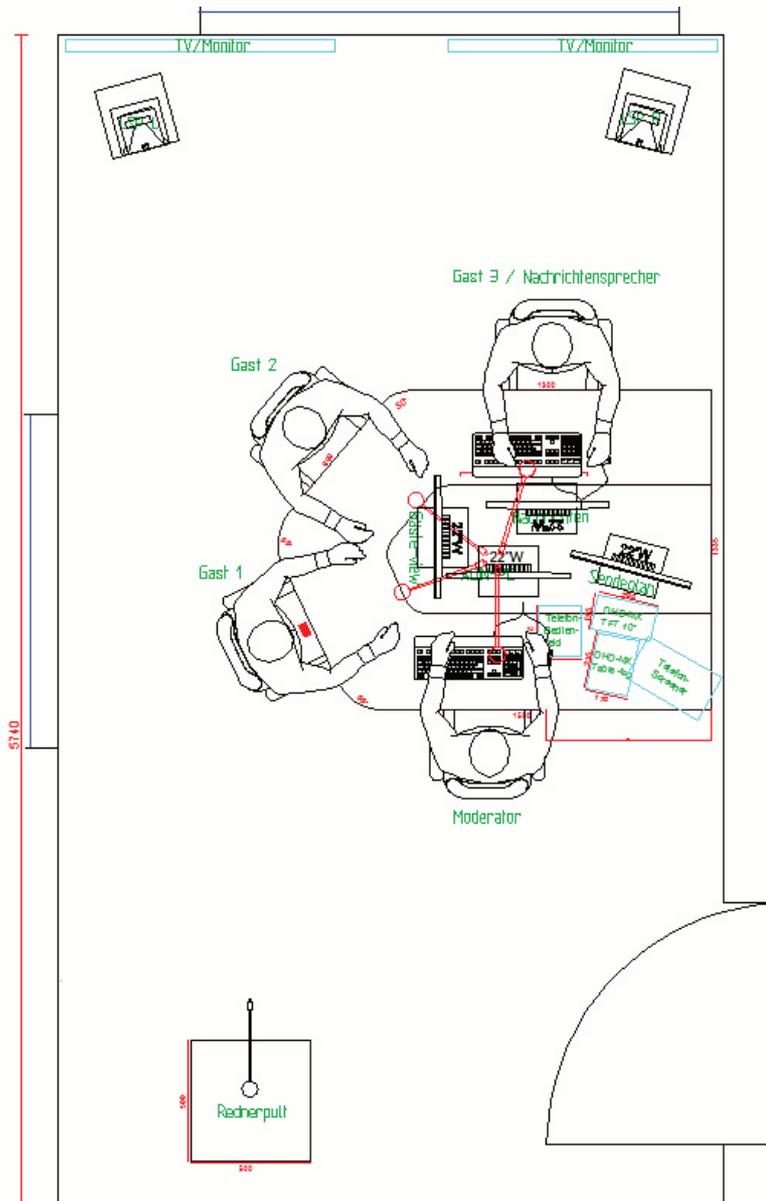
Grundriss Studio 2 mit neuen Möbeln
